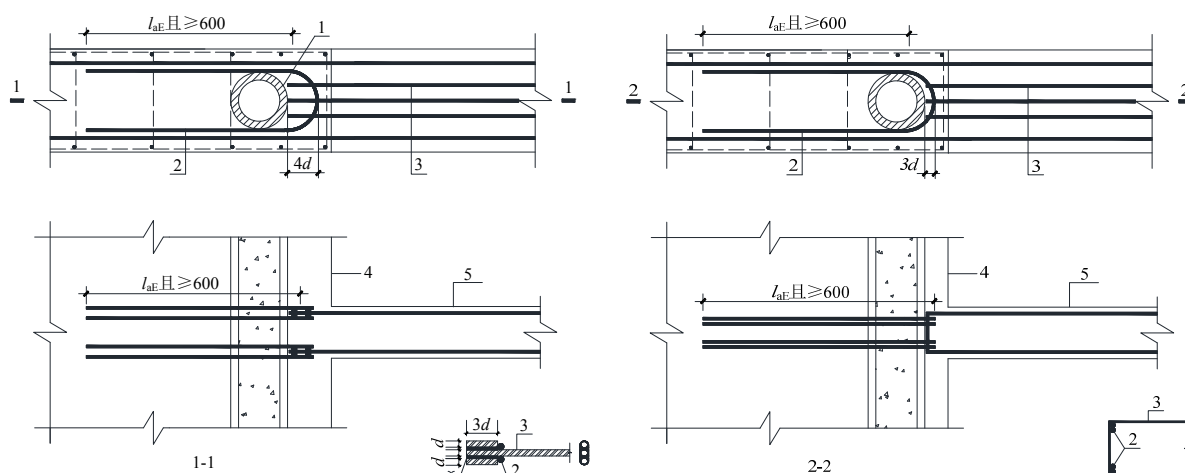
钢筋混凝土连梁纵筋锚固构造图
